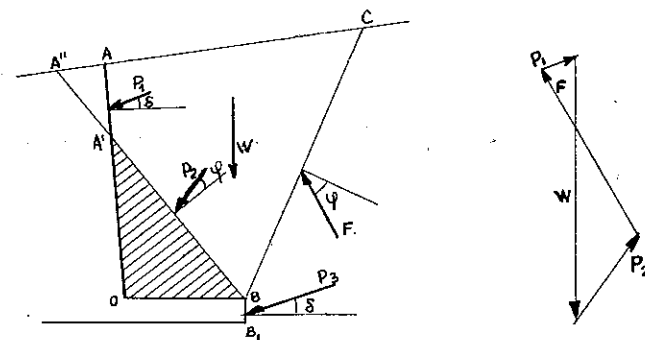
Calcul de la poussée sur un mur de soutènement en béton armé.
